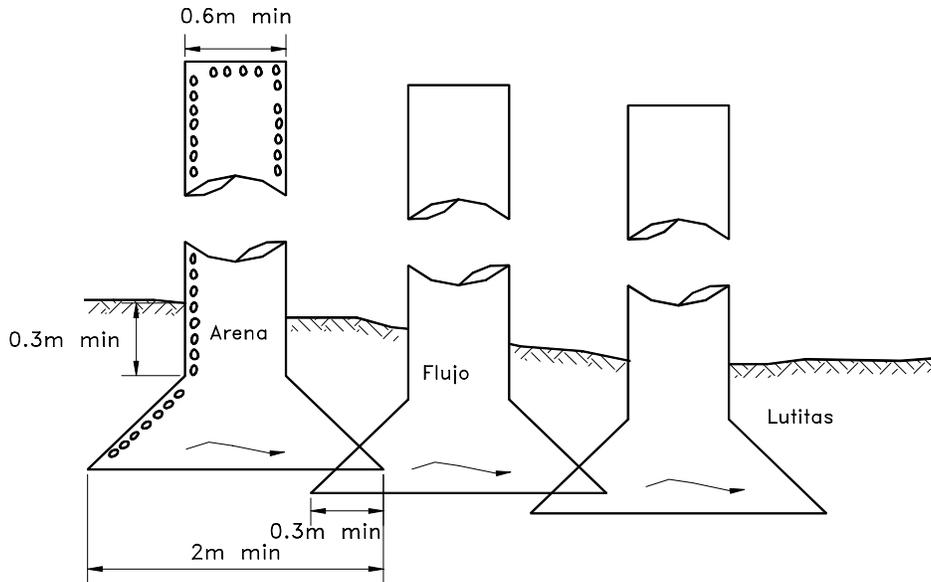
Pozos verticales acampanados que se traslapan en el pie (Colorado Department of Transportation).
